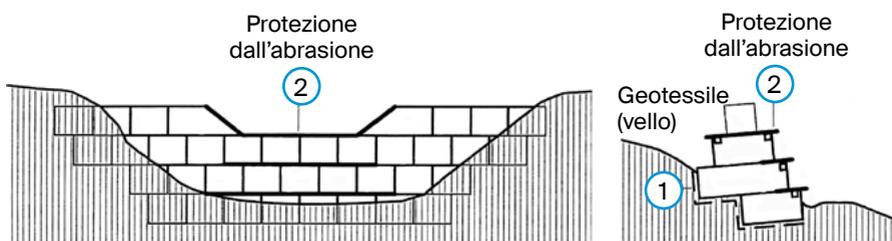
Briglia con gabbioni, variante B: prospetto e sezione (USTRA)
